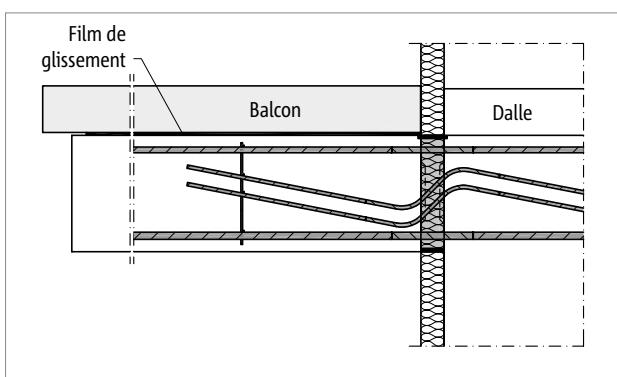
Schöck Isokorb® T Type B : Construction de balcon avec poutrelles en porte-à-faux (balcon préfabriqué)
